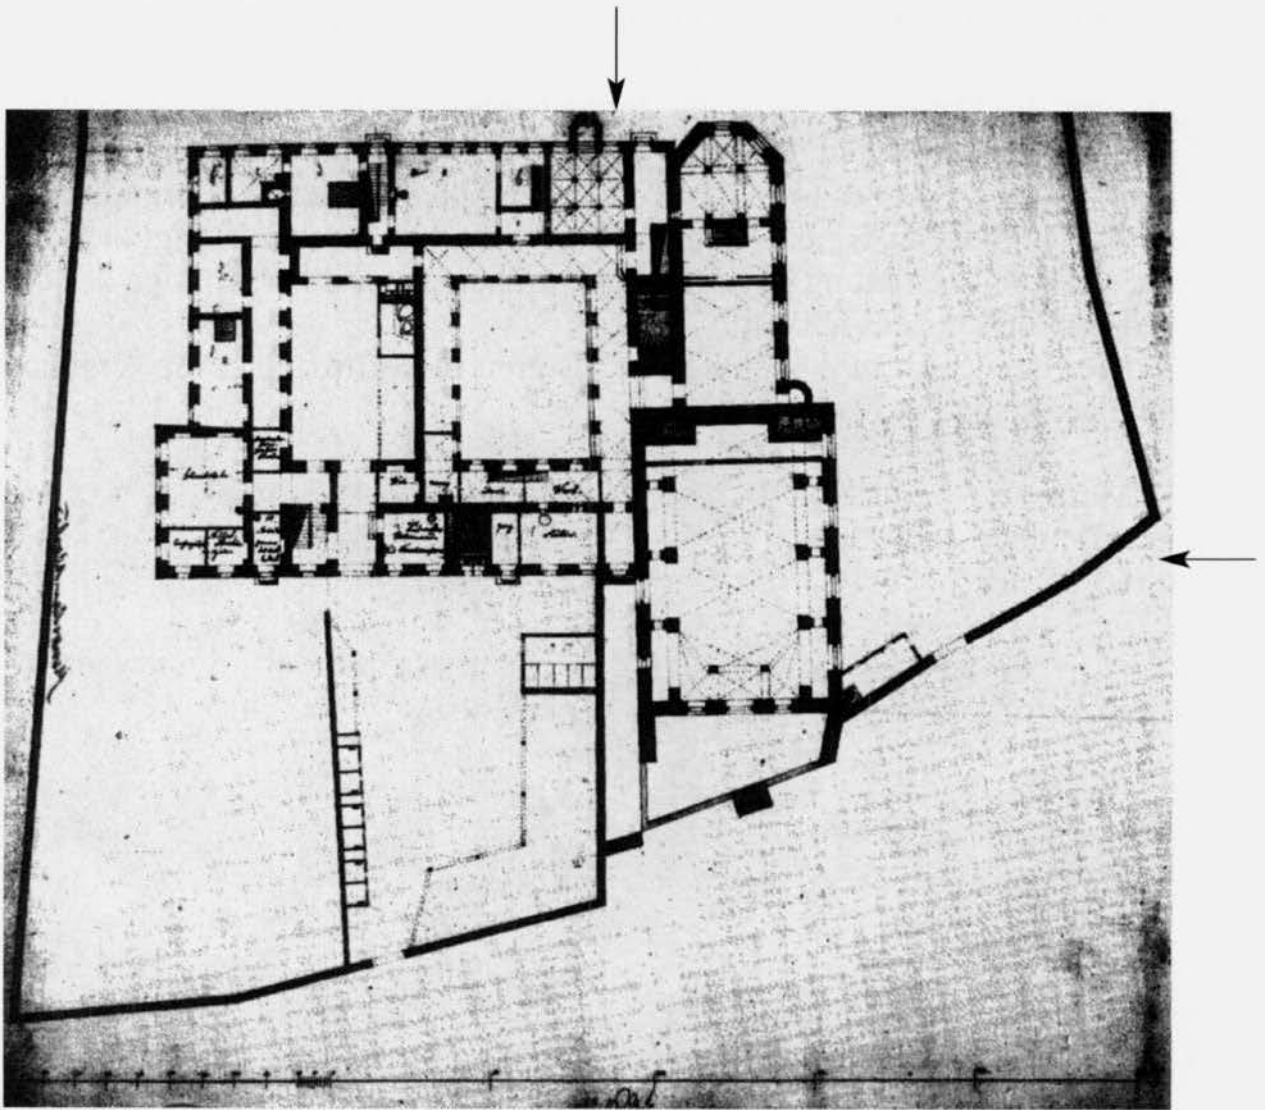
Grundriss des Franziskanerklosters mit Platzierung der Tür.
